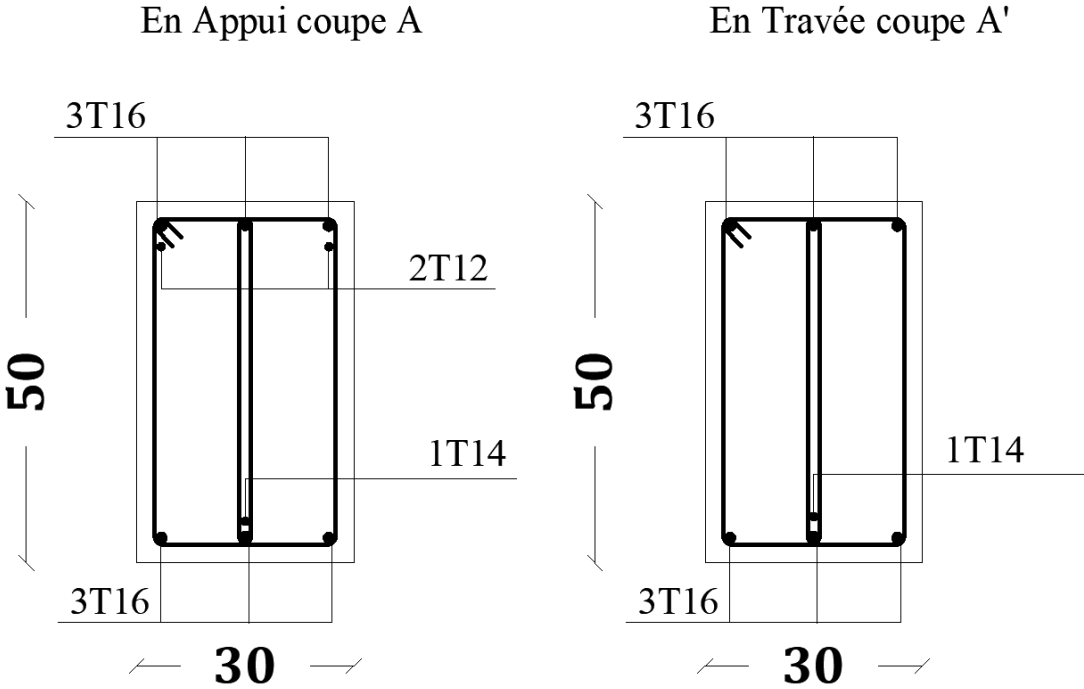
Schéma de ferrailage de la poutre principale 30x50
